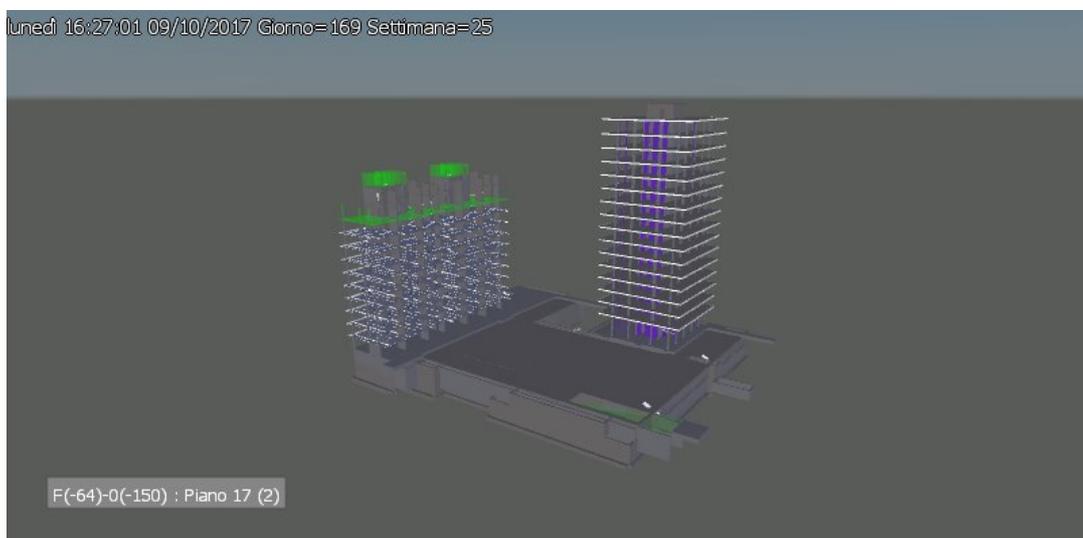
Simulazione 4D - Struttura Tower ultimata ed elevazione vani scala B e C Garden
